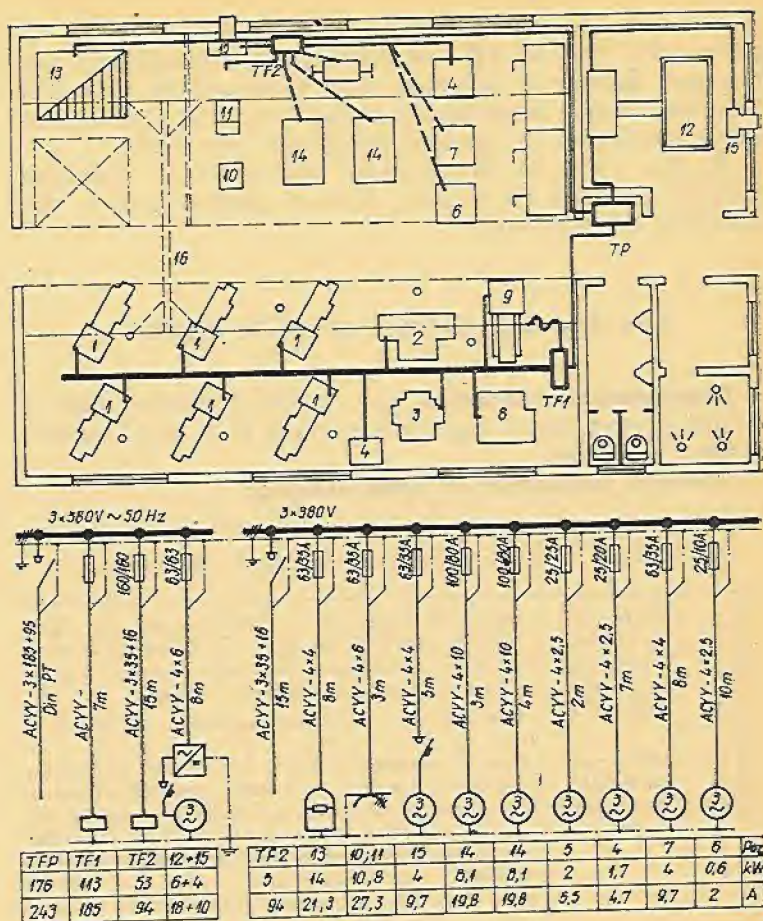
Planul și schema instalației electrice de forță din exemplul de calcul 11.9:
